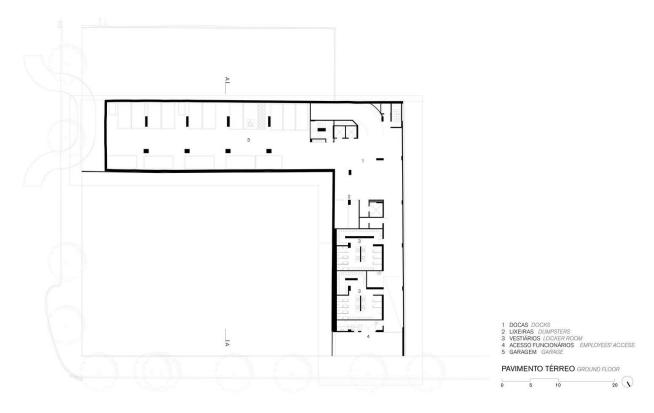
Planta baixa do primeiro pavimento do Hotel Fasano
